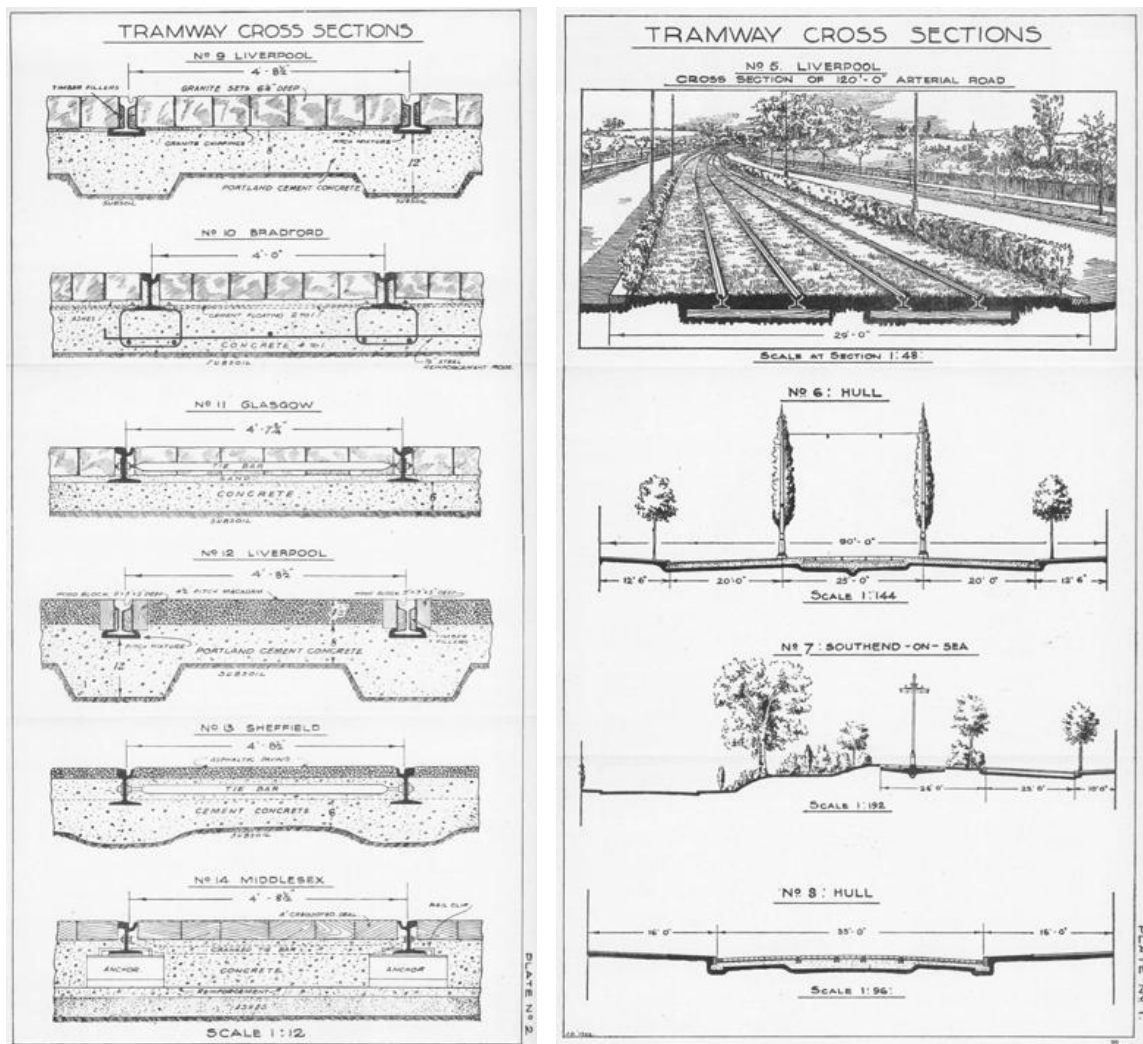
> El ingeniero civil de Liverpool presenta en el PIARC celebrado en Sevilla un estudio de los distintos sistemas empleados para la pavimentación de las calles con raíles de tranvía en el Reino Unido (Brodie. 1923. PIARC)
